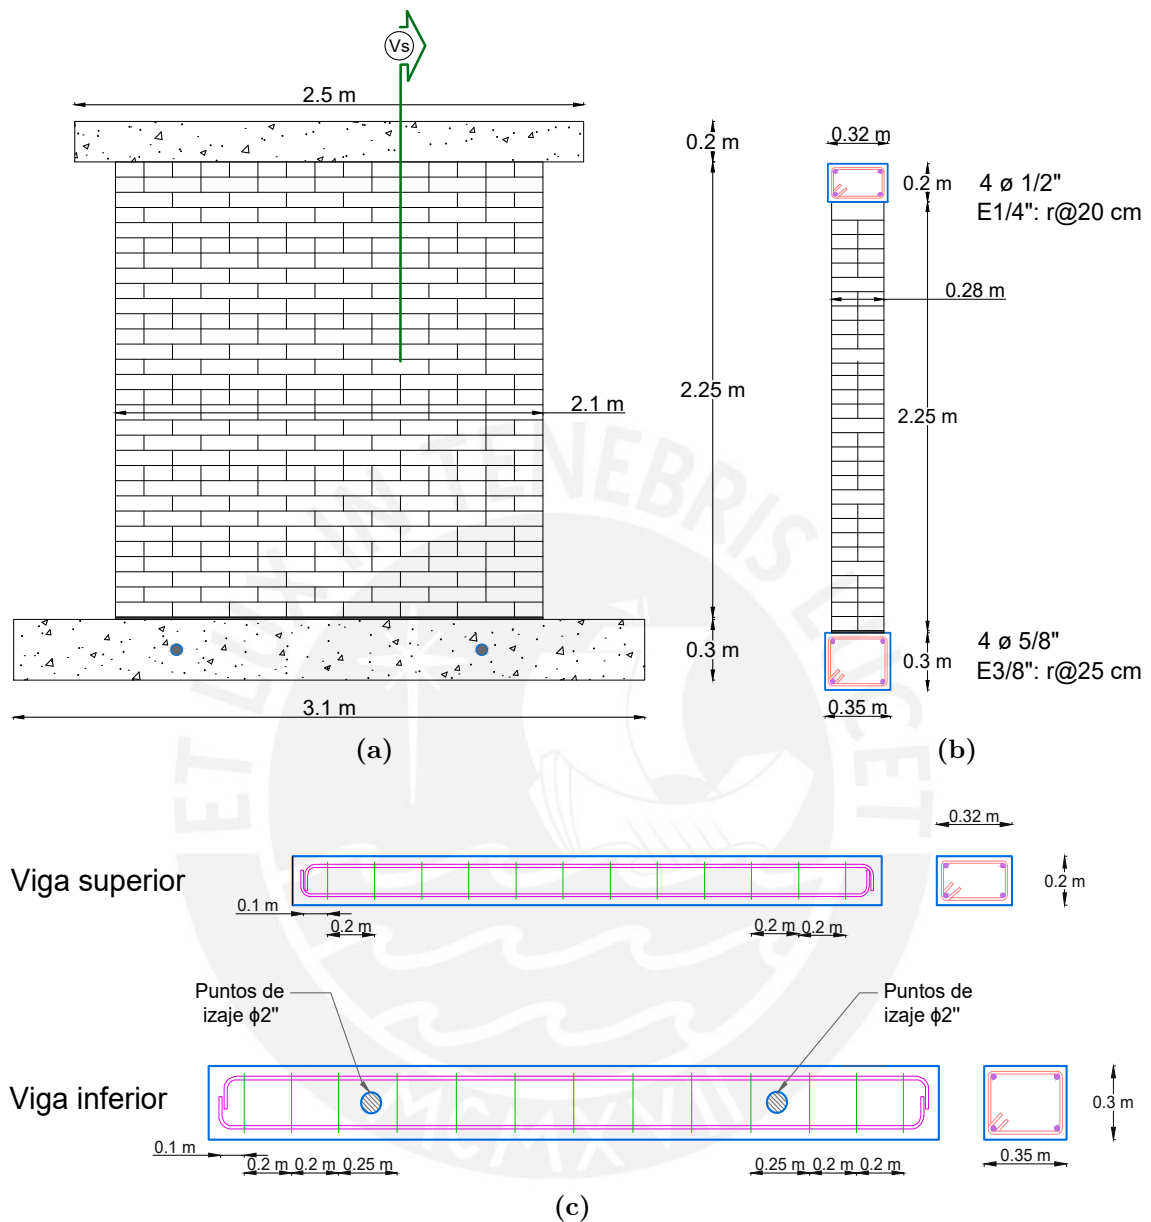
(a) Vista frontal del muro y vigas inferior y superior, (b) vista en corte del sistema con detalle de acero de las vigas y (c) detalle del acero longitudinal en las vigas.
